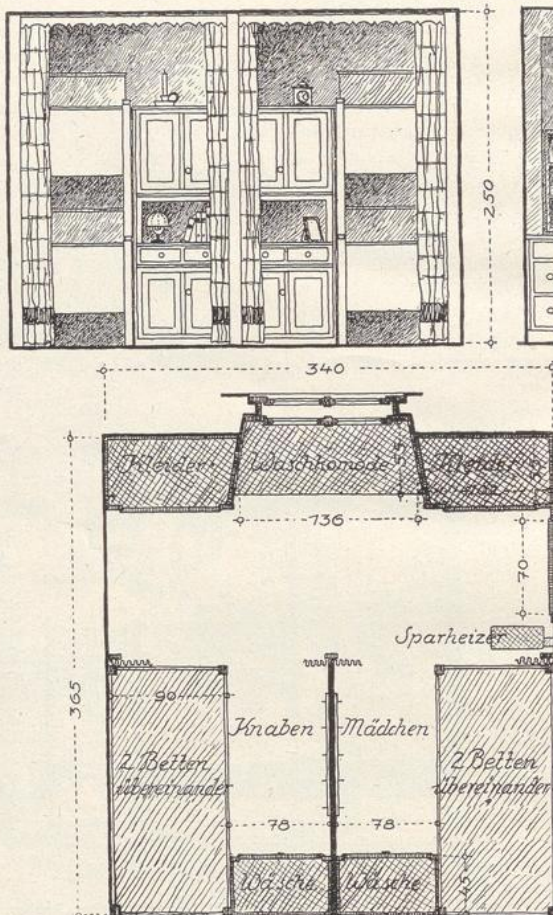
Ansicht und Grundriß des Kinderschlafzimmers (1:50)
